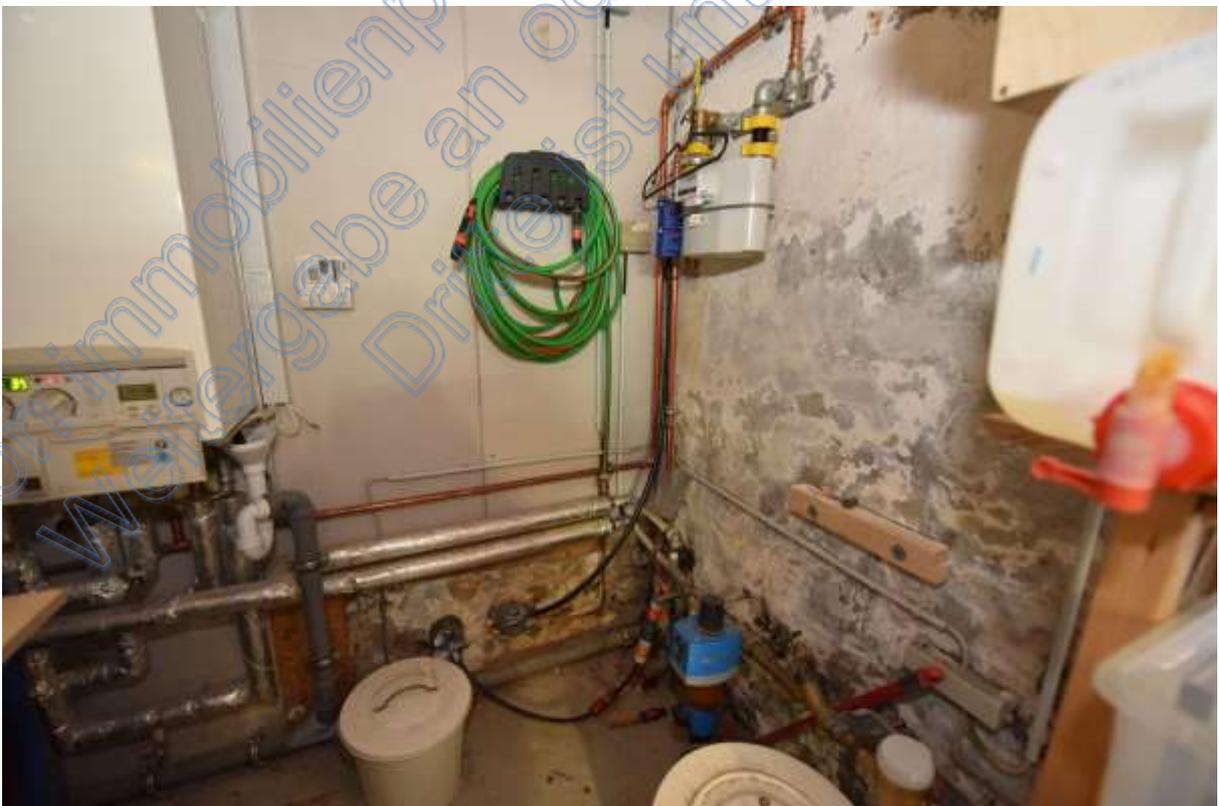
Erdgeschoss: Abstellraum, Gasterme und Hausanschlüsse
